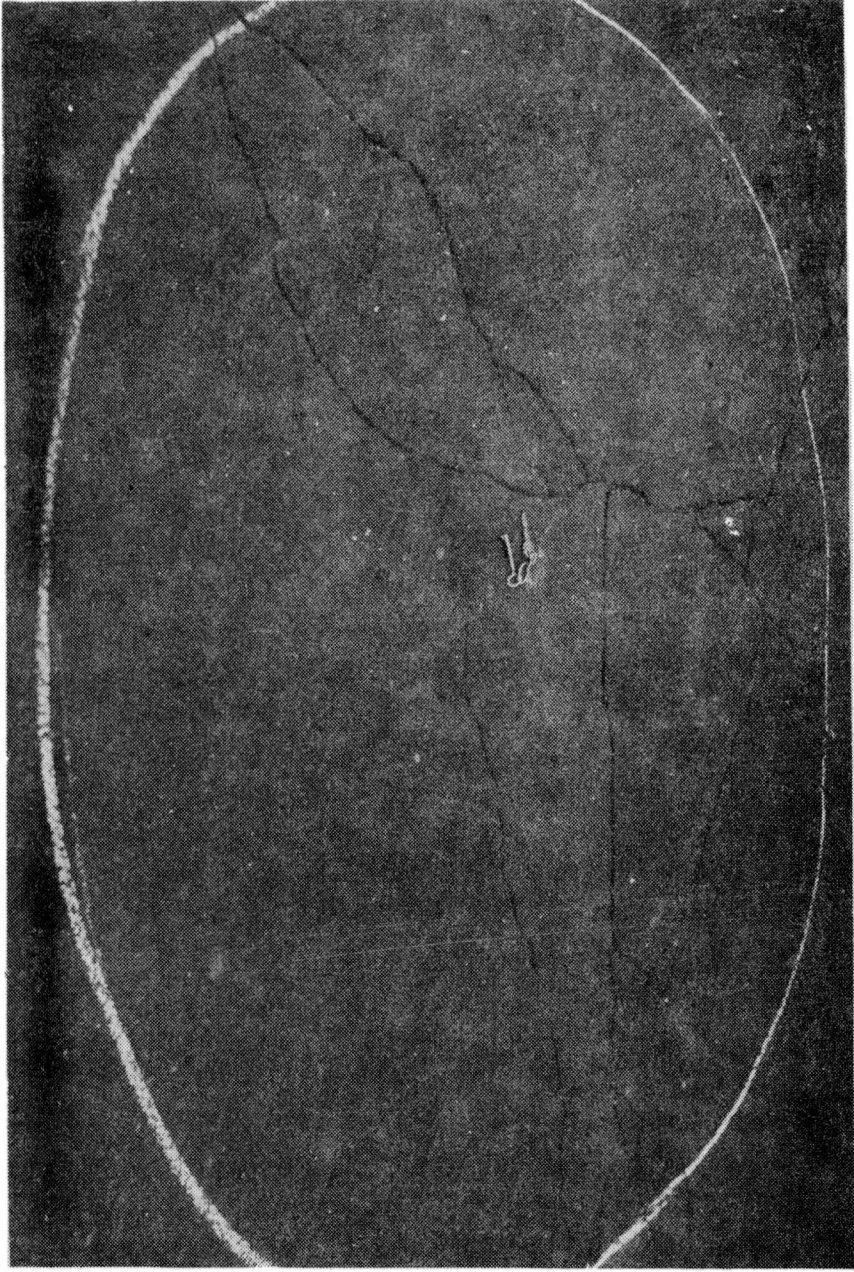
Fisuras debidas a la contracción de la carpeta
